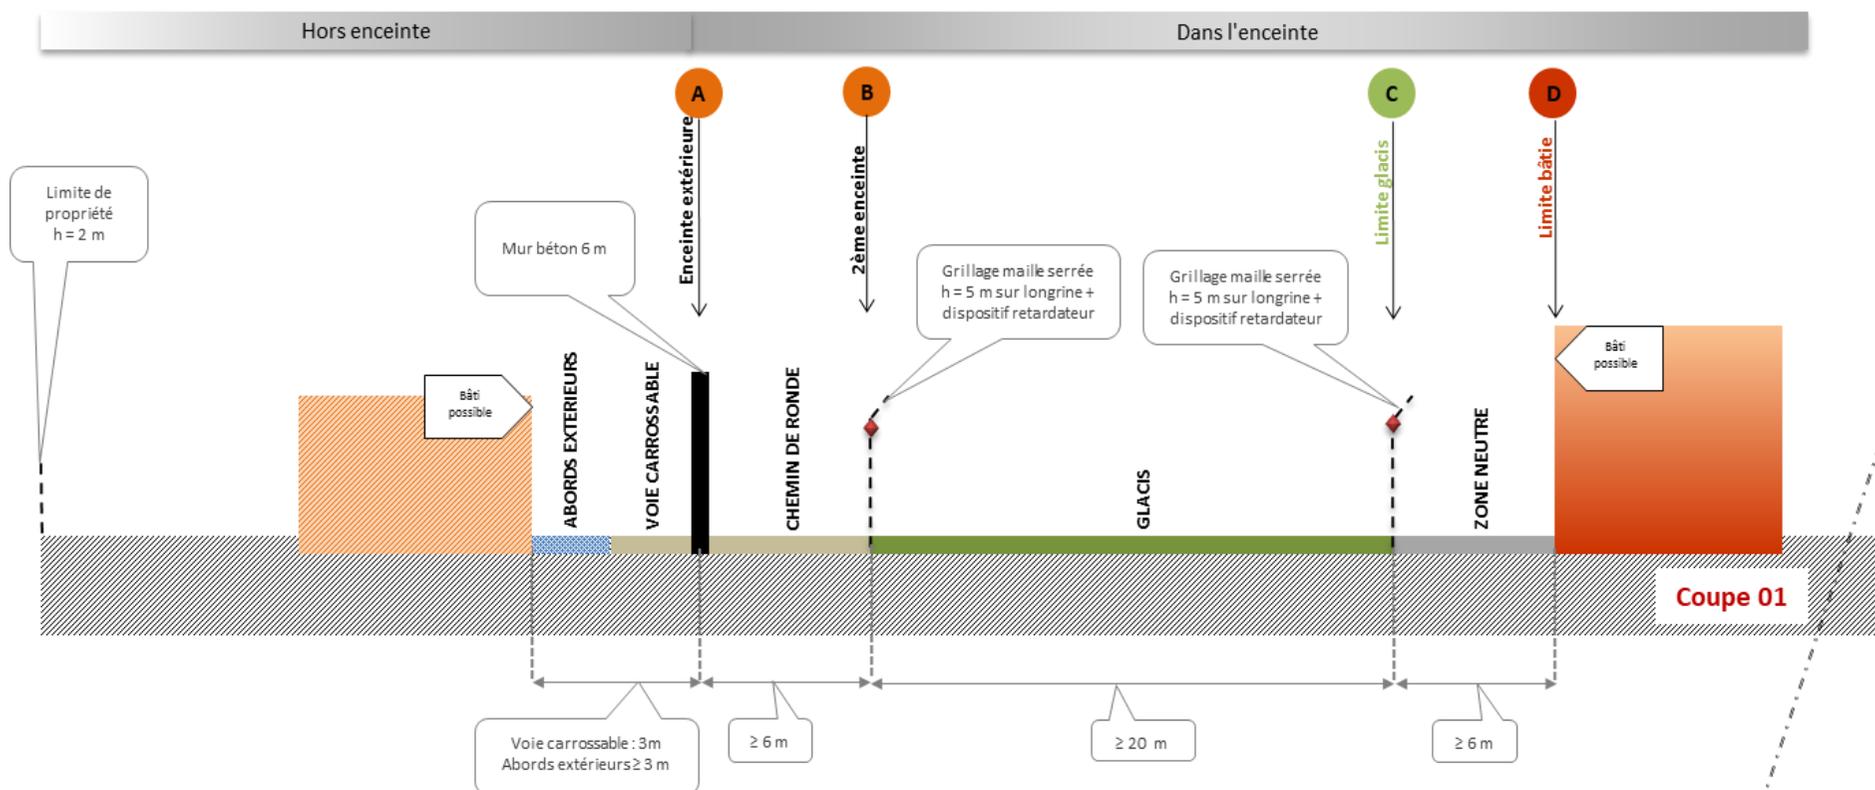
Coupe 1 - Enceinte délimitée par un mur béton de 6 m de haut (Source : APIJ)
